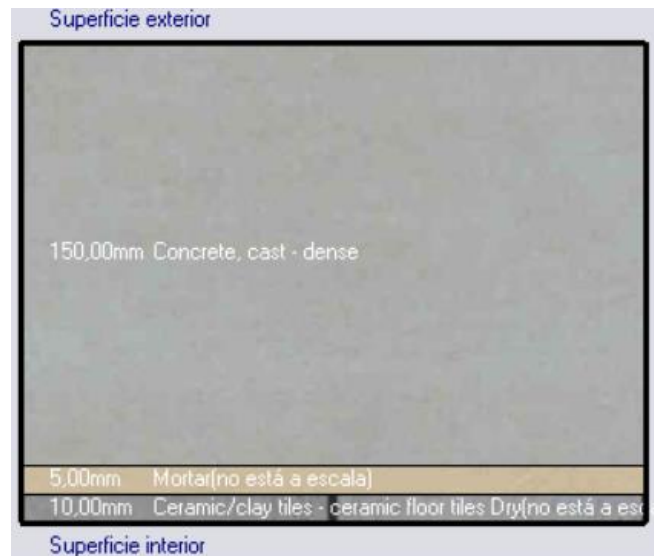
Losa sobre el terreno del edificio. Fuente: Propia
